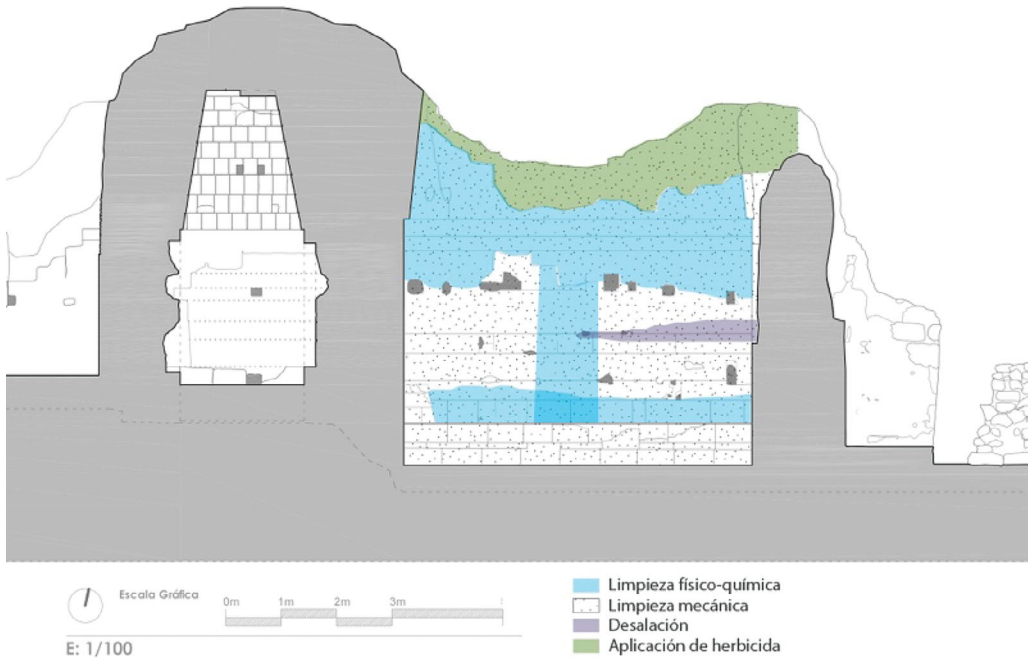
Propuesta para la limpieza del muro N, 6J2-4. Basado en plano de levantamiento arquitectónico del Proyecto La Blanca (Muñoz G., Matarredona N. y Marín B. 2007), modificado por la autora.
